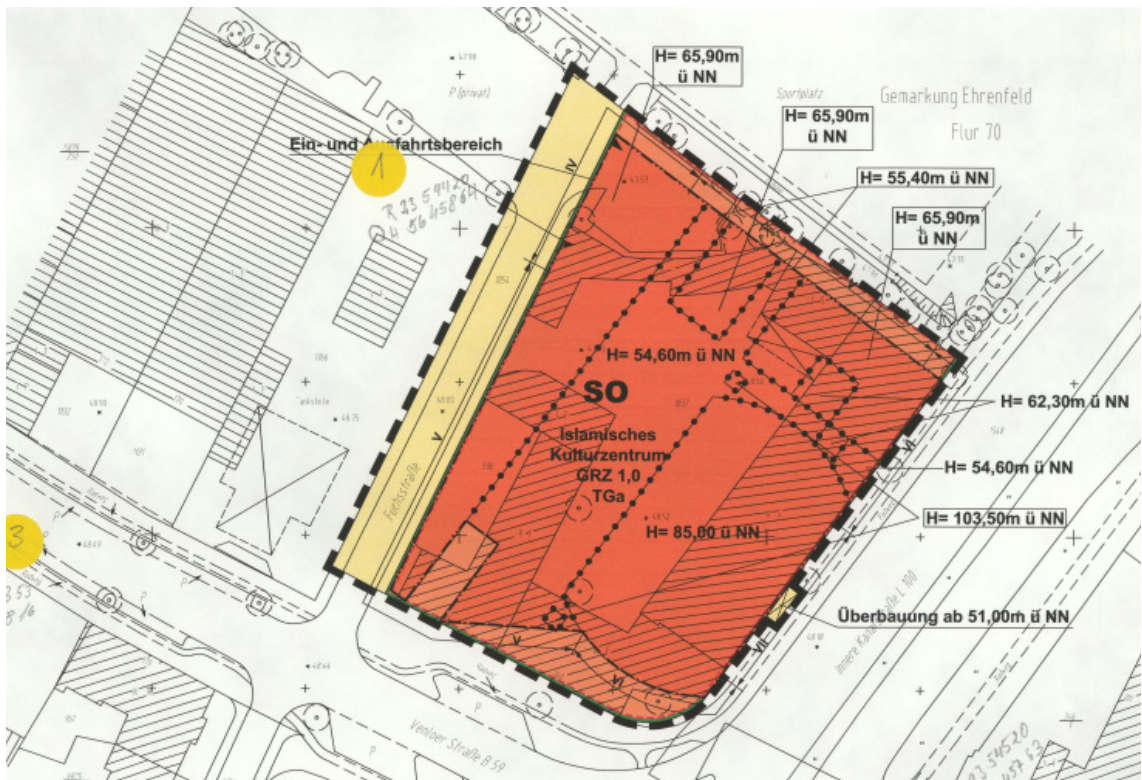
Ausschnitt aus der 3. Änderung des Bebauungsplans Nr. 65460/06 der Stadt Köln, unmaßstäblich.
